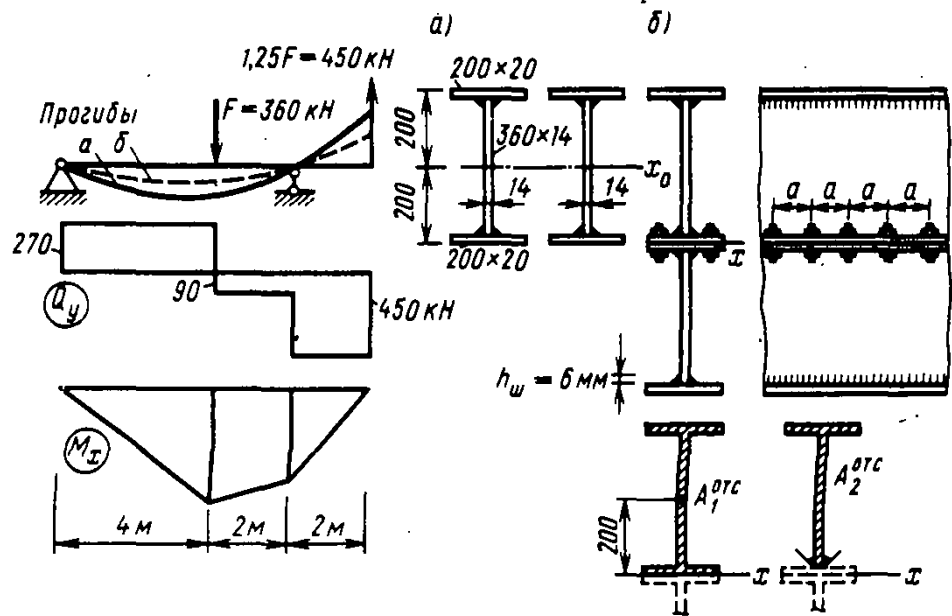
К примеру 7.3. Расчет балки со сварными и болтовыми соединениями:
